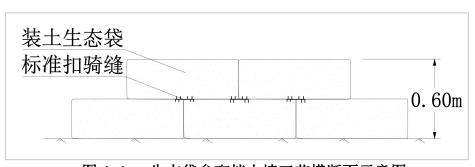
生态袋垒砌挡土墙工艺横断面示意图
